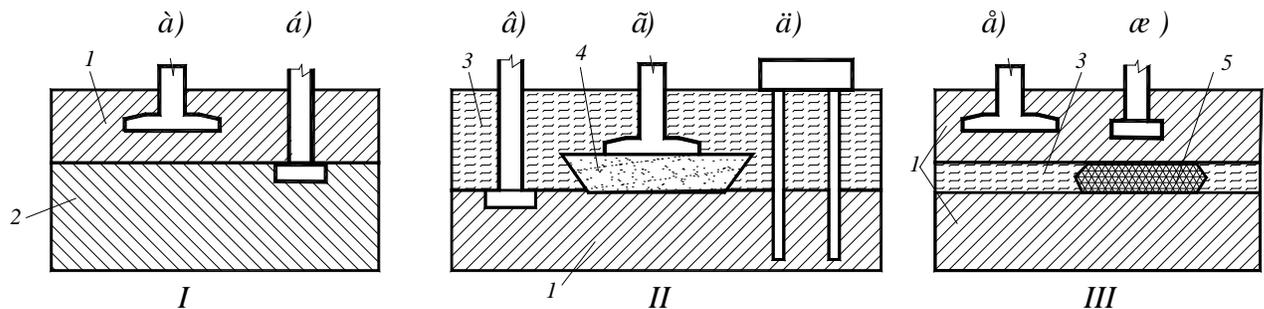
Схемы напластований грунтов с вариантами устройства фундаментов
